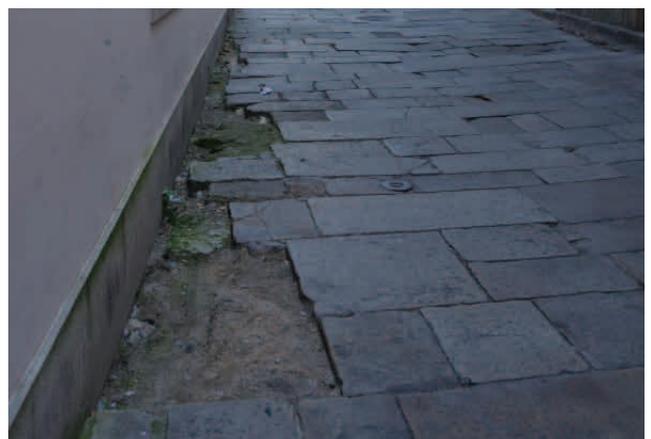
Enlosado de granito en mal estado (fuente propia, Tsla. Puerta de Aires)
